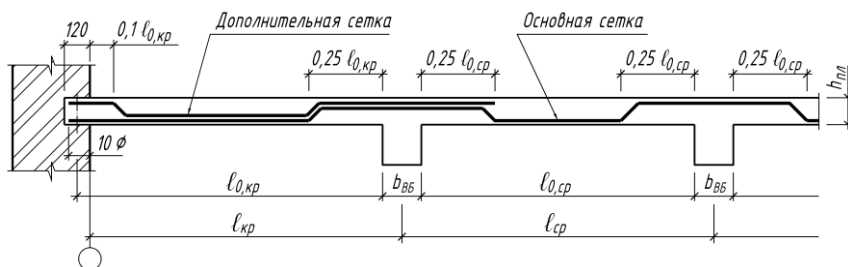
Схема армирования плиты сварными рулонными сетками
